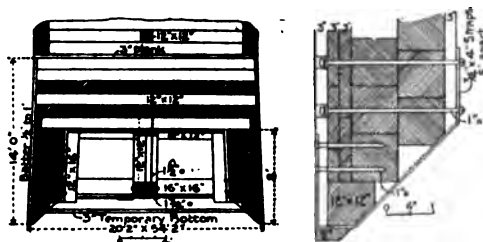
Pont de Fort Madison. Caisson Sooy Smith et détails du couteau (d'après l'Engineering News).
